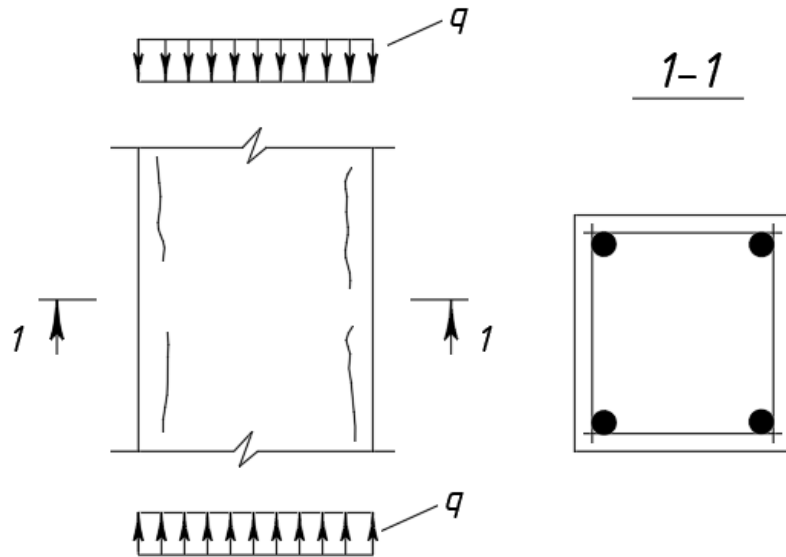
Тріщини вздовж поздовжньої арматури в стиснутих елементах
